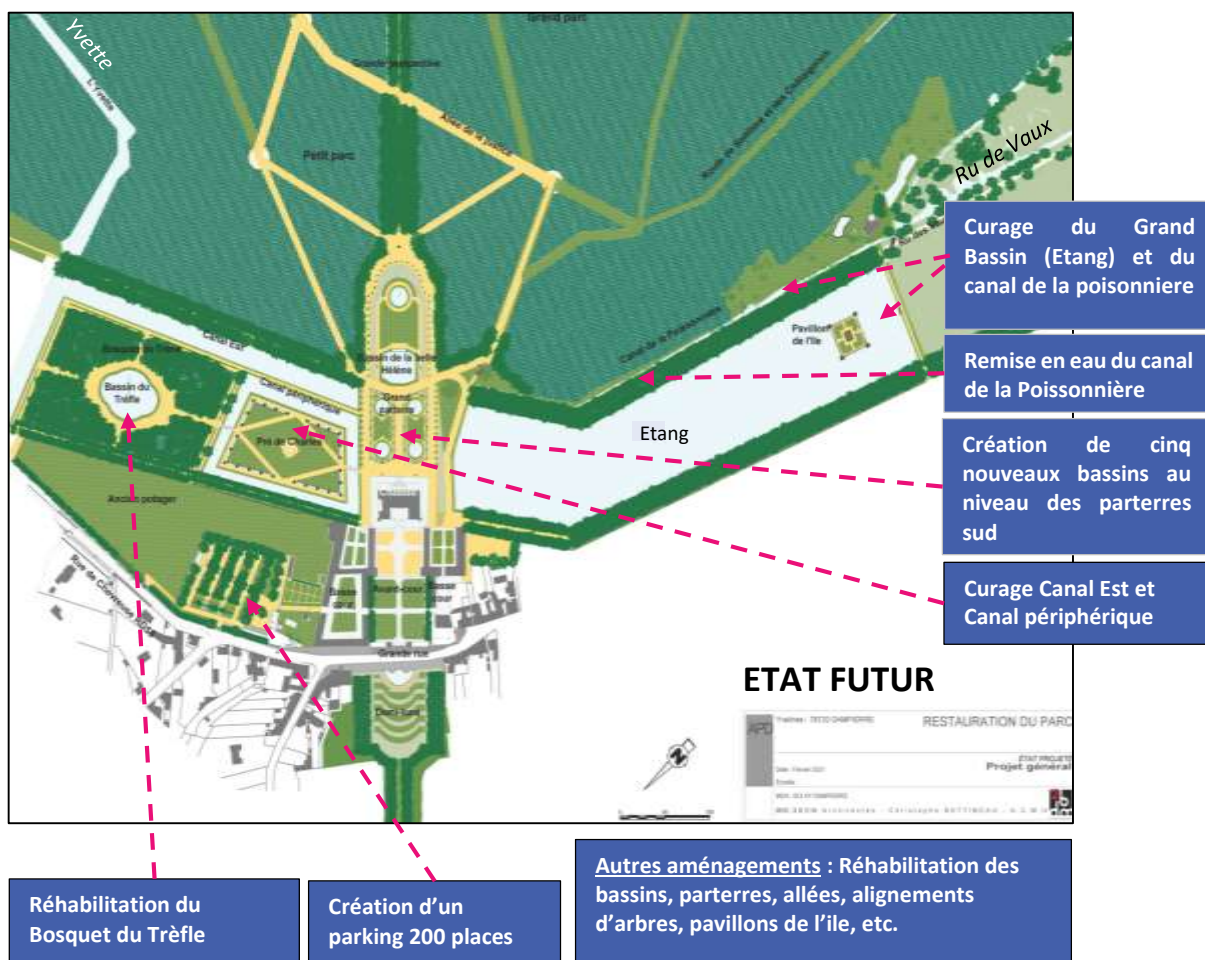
Plan projet (source volet D du dossier plan 2bdm)
